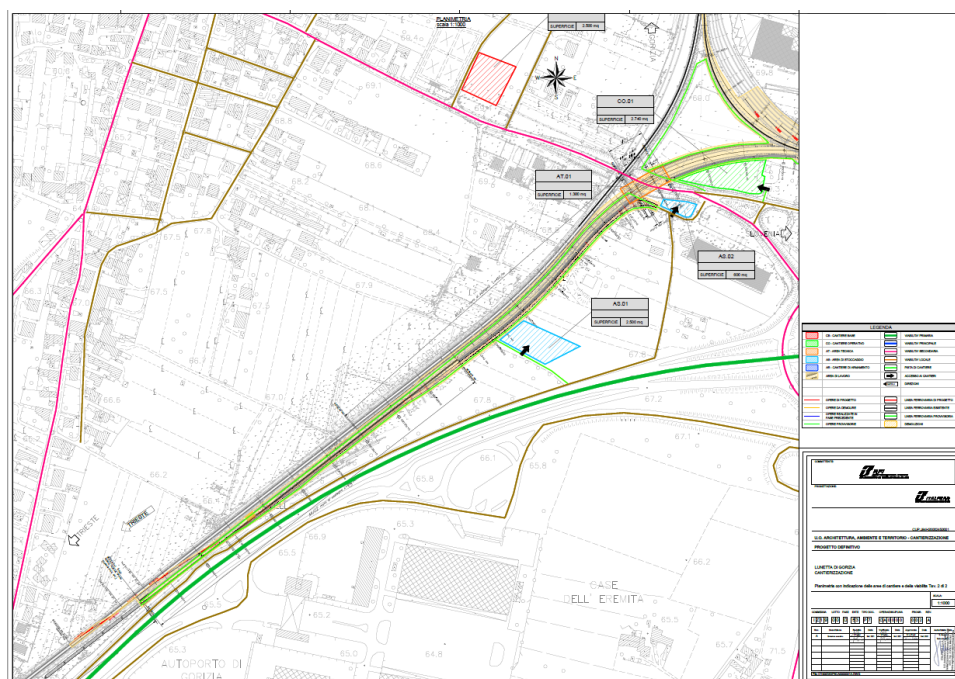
Planimetria con indicazione delle aree di cantiere e della viabilità – Tav.2.
